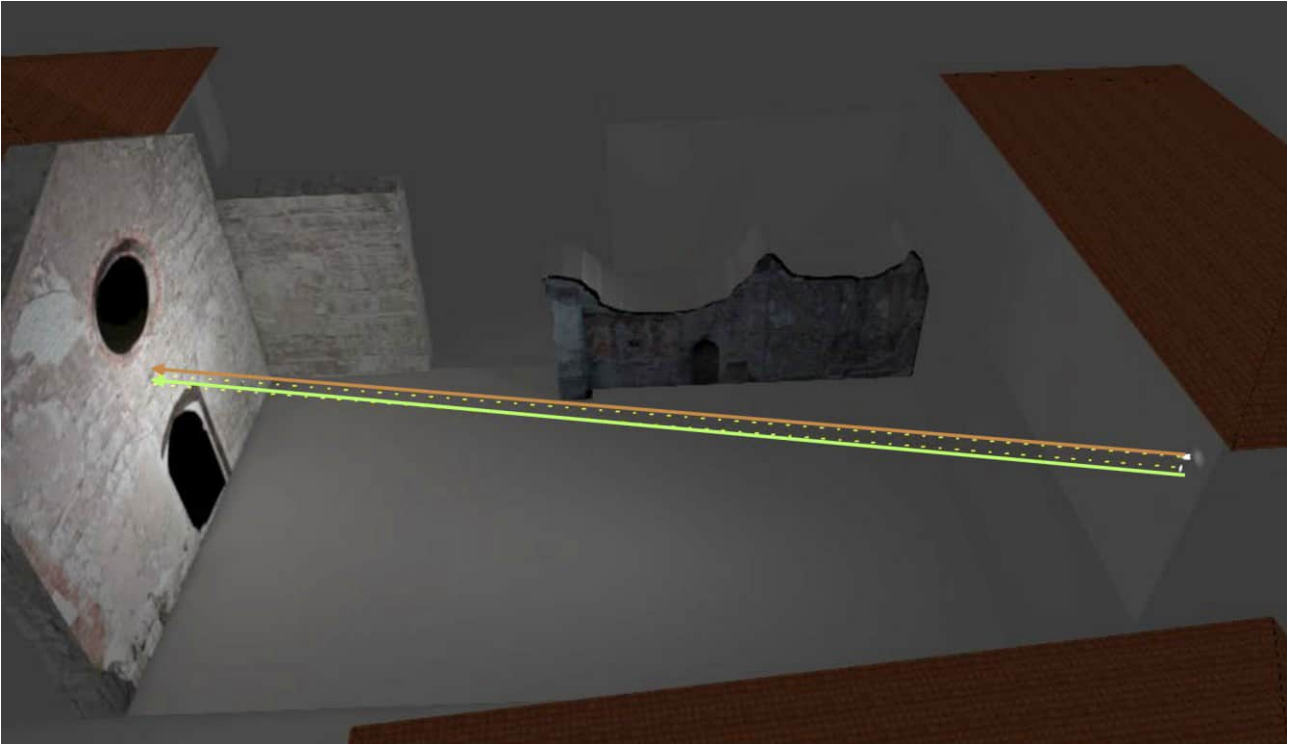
Progetto – Illuminazione Chiesa di San Giovanni
